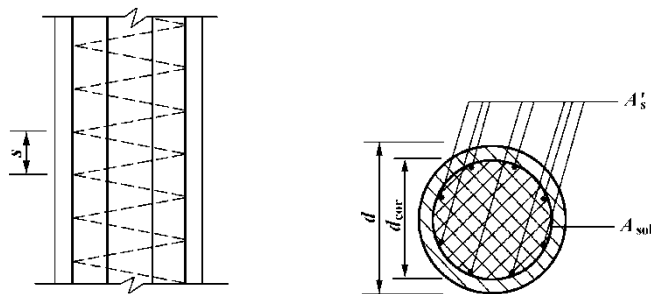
配置螺旋式间接钢筋的钢筋混凝土轴心受压构件截面图
